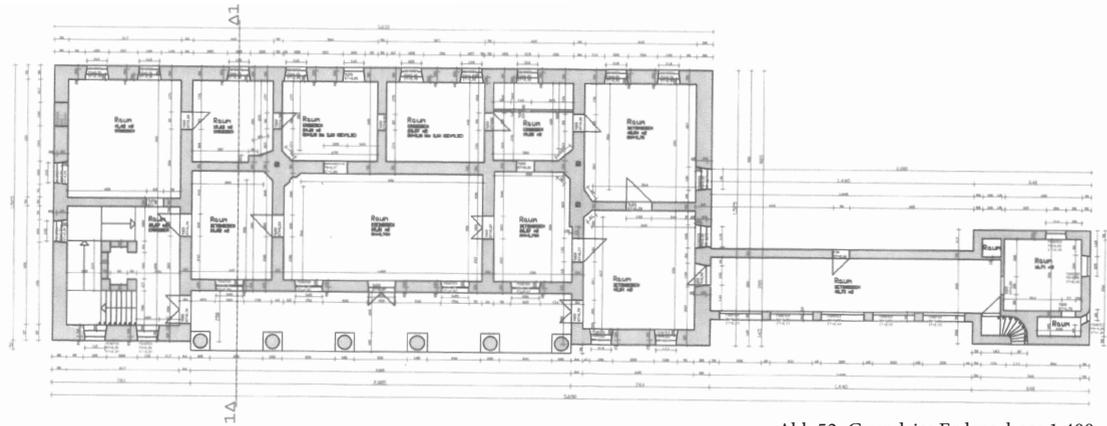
Grundriss Erdgeschoss 1:400
